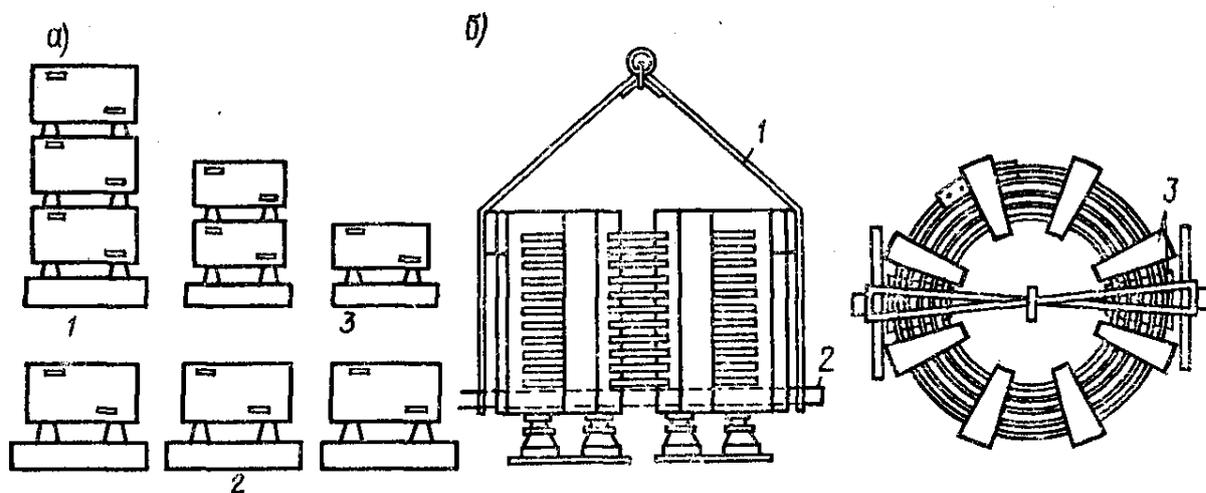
Реактор типа РБА-10-600-6: *а* - способы установки трехфазного комплекта реактора; *1* - вертикально; *2* - горизонтально; *3* - ступенчато; *б* - крепления стропов при подъеме; *1* - стальной трос; *2* - швеллер; *3* - деревянные прокладки
